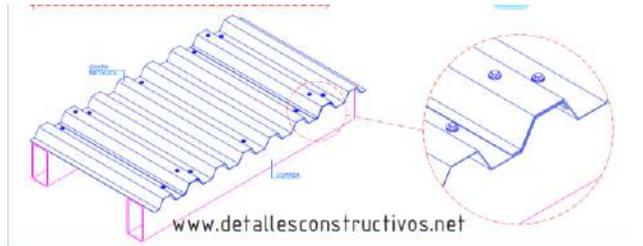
Losacero, Google imágenes, www.detallesconstructivos.net 21/06/2021]
